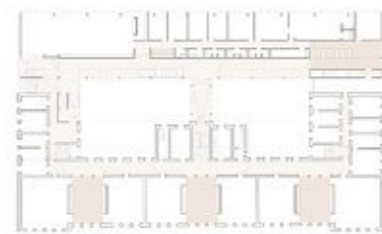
Grundriss Obergeschoss, Neues Gymnasium Wilhelmshaven (D)
